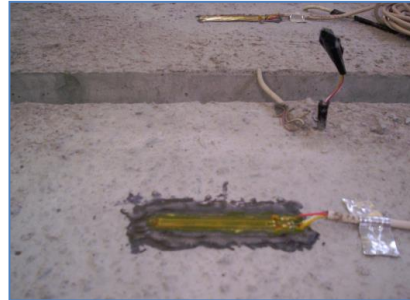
Colocación de deformímetros eléctricos tipo EA-06-20CBW-120 en el concreto.
